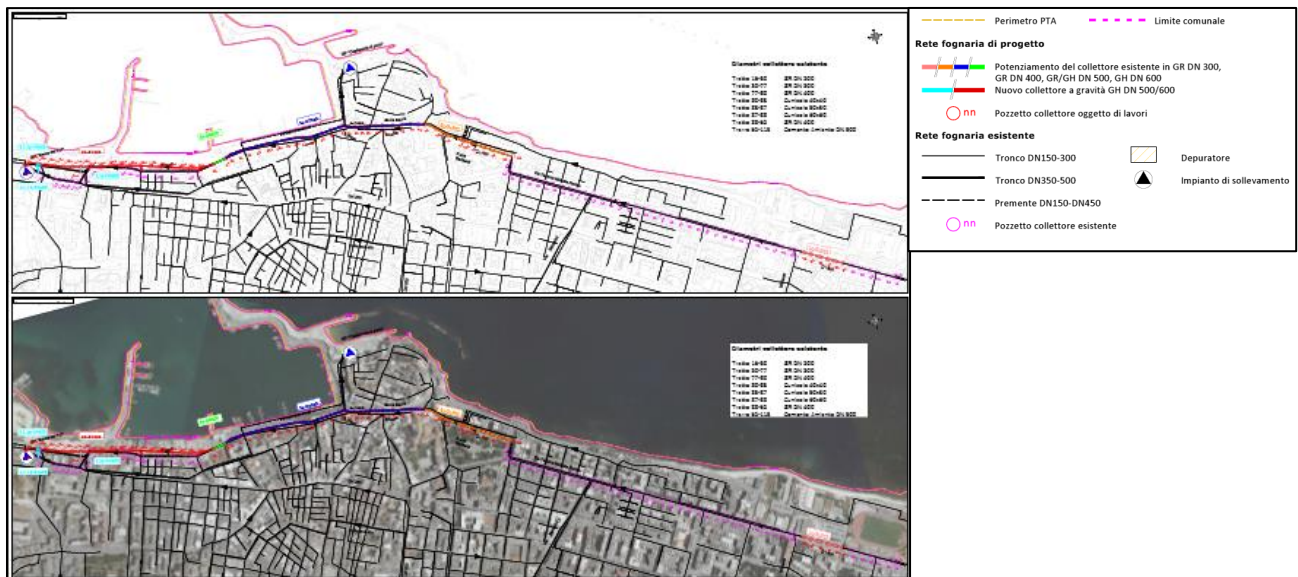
Stralcio della planimetria di progetto rete fognaria – Molfetta
